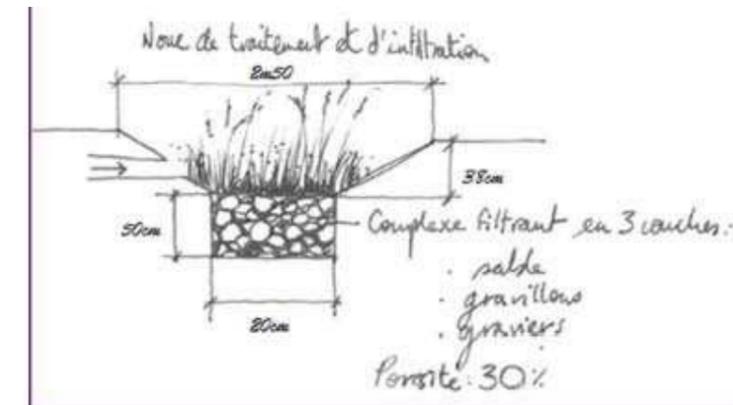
Coupe d'une noue (source : dossier loi sur l'eau, p.73)
